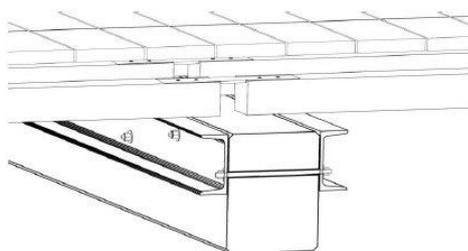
Reforço de viga através da colocação de perfis UNP (Mariani, 2004)
